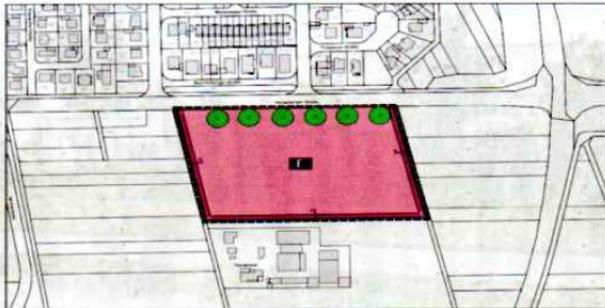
Bebauungsplan „Feuerwache Heidelberger Straße“ (Stand: 03.04.2023). Quelle: PlanEs.
